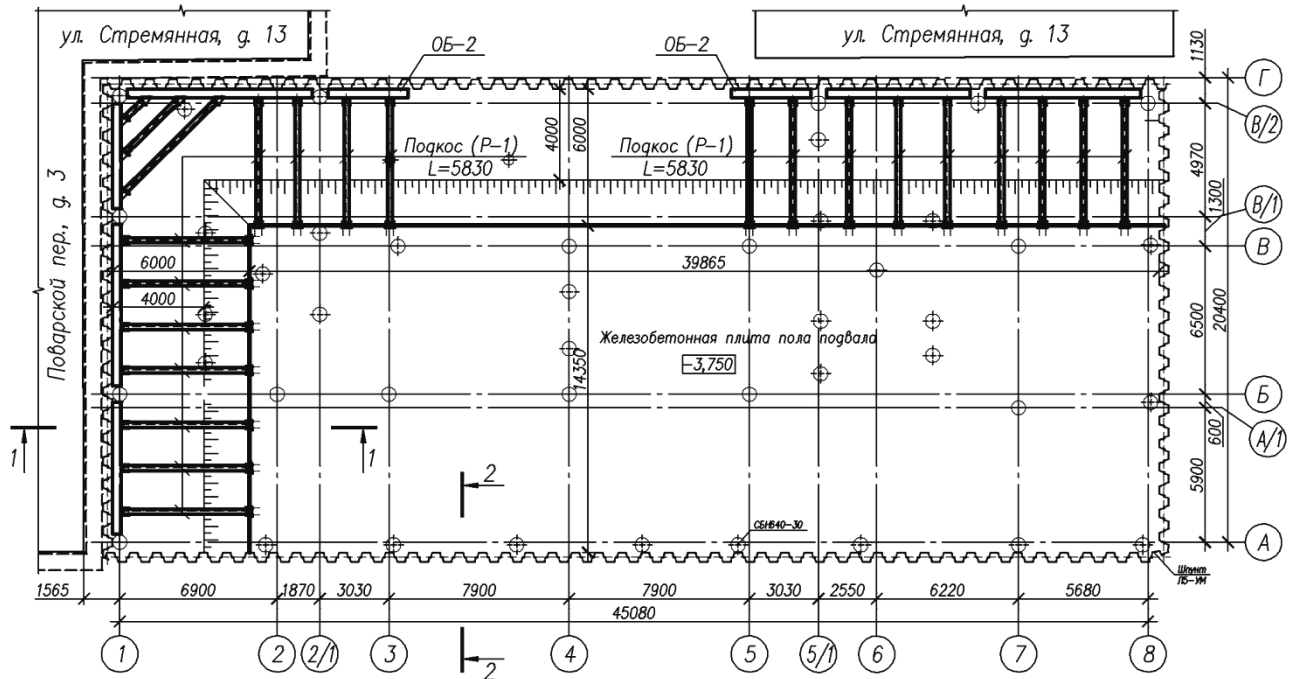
а) схема разработки котлована комплексным методом на этапе 1;
